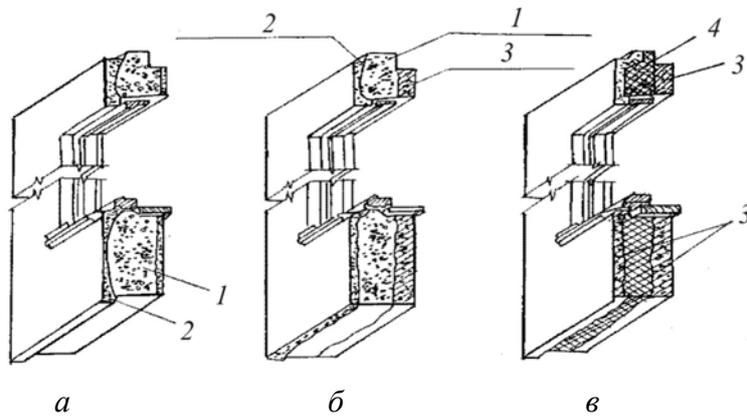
Бетонные панели наружных стен: *а* — однослойная; *б* — двухслойная; *в* — трехслойная: 1 — конструктивно-теплоизоляционный бетон; 2 — защитно-отделочный слой; 3 — конструктивный бетон; 4 — эффективный утеплитель
